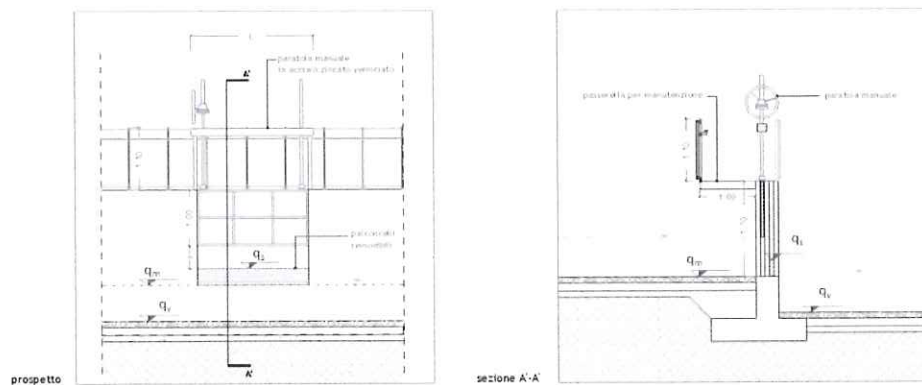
Prospetto e sezione briglia di regolazione Canale perimetrale
